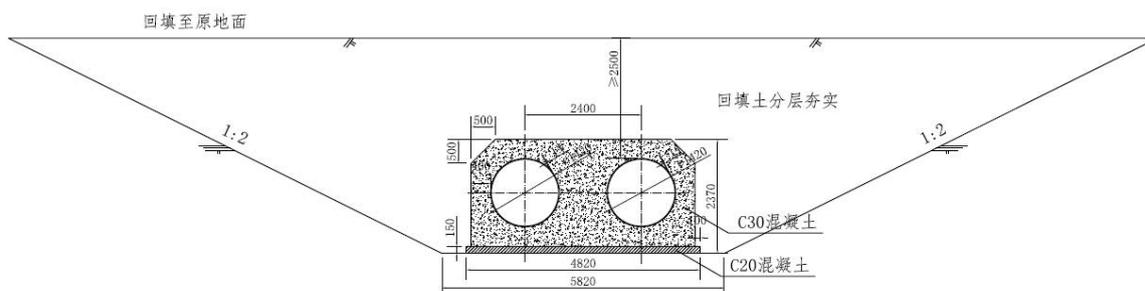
供水管道穿越减河横断面图
